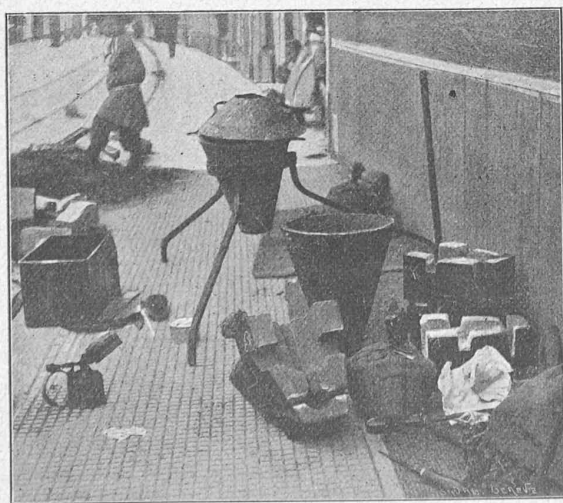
Vue de l'outillage pour la soudure des joints de rails par le procédé aluminothermique.
